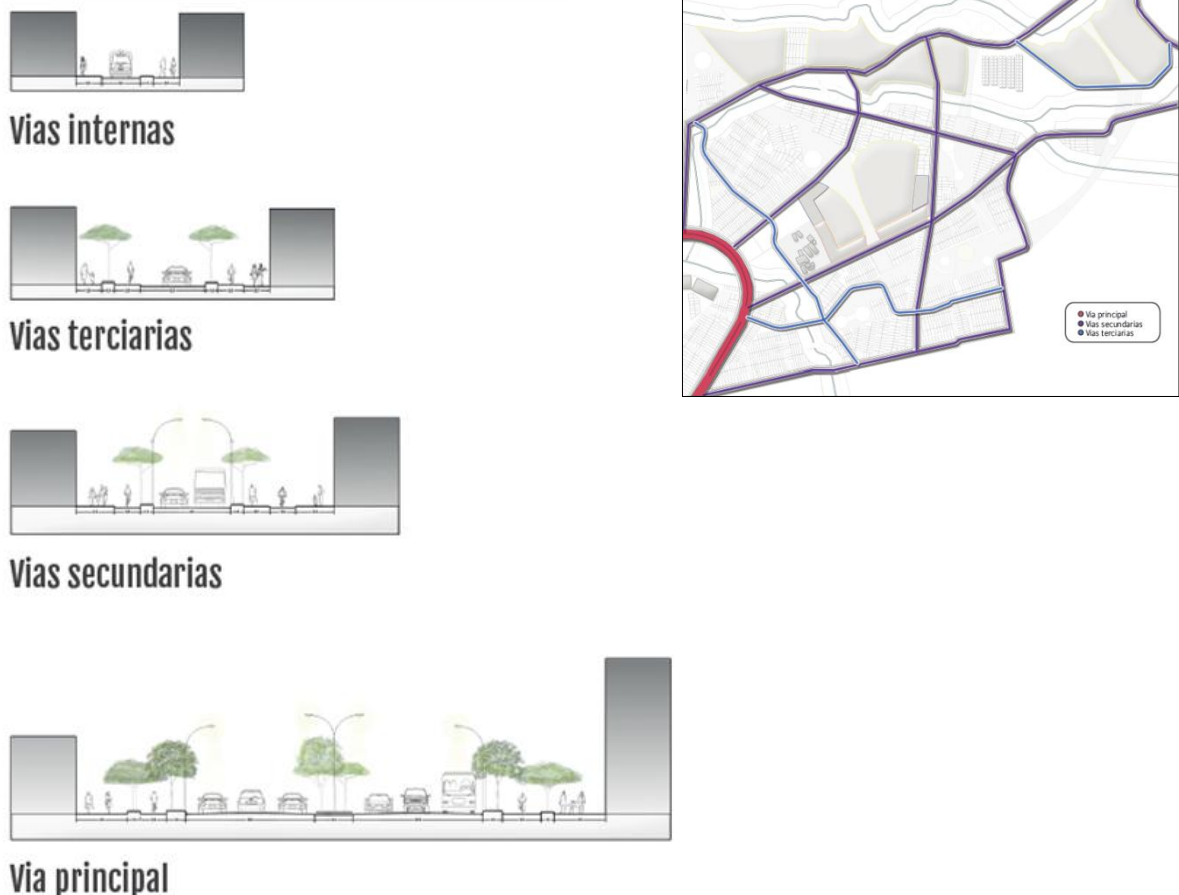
Propuesta de conectividad en el sector Bolonia.
